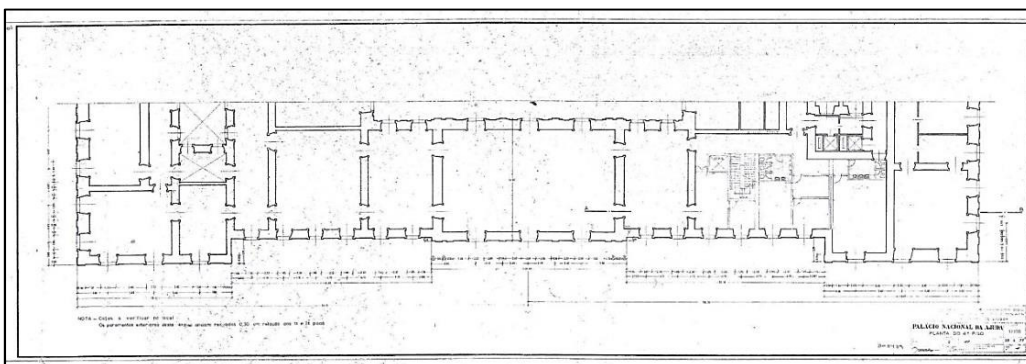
Planta do 4.º piso da Ala Poente. Projeto de João Seabra, 1977.
